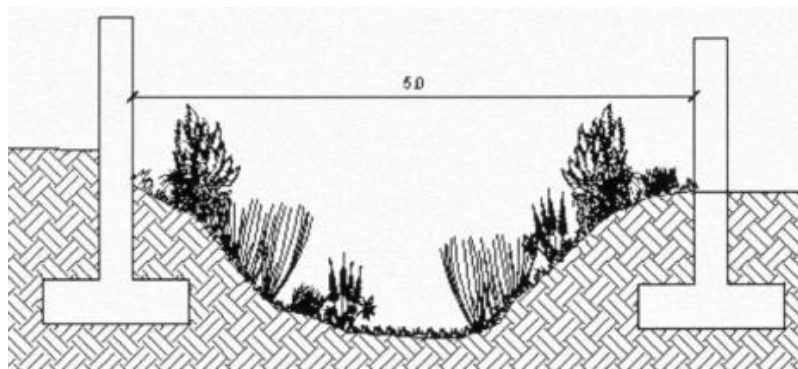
Corte do canal reperfilado na zona do loteamento.
